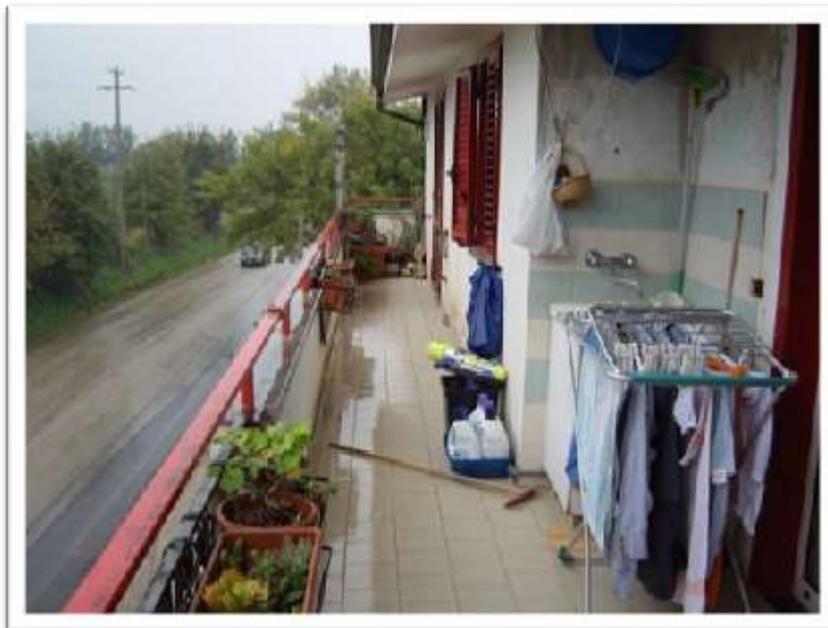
Lotto n.3 - Balcone - Piano terzo - Foglio 9, P.Ila 31 I, sub 6
